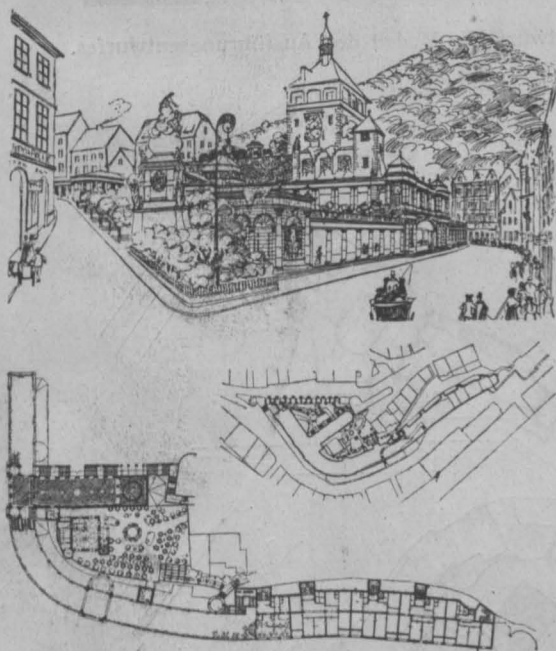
Entwurf VI. Schaubild und Grundriß.
